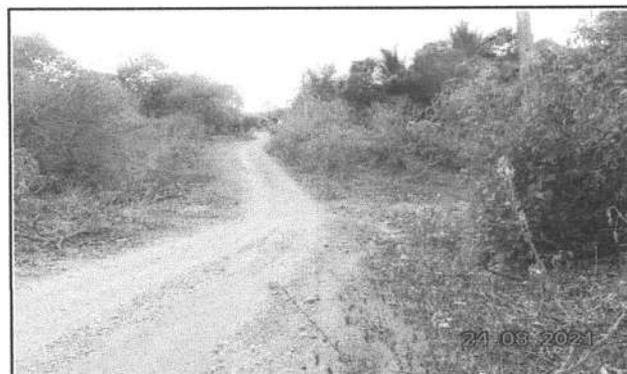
LOCAL DA CONSTRUÇÃO-BUEIRO
